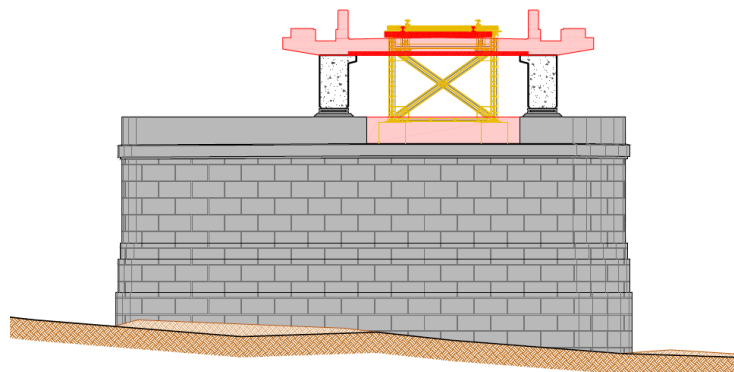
Execução da vigas da ponte do Caia [43]
